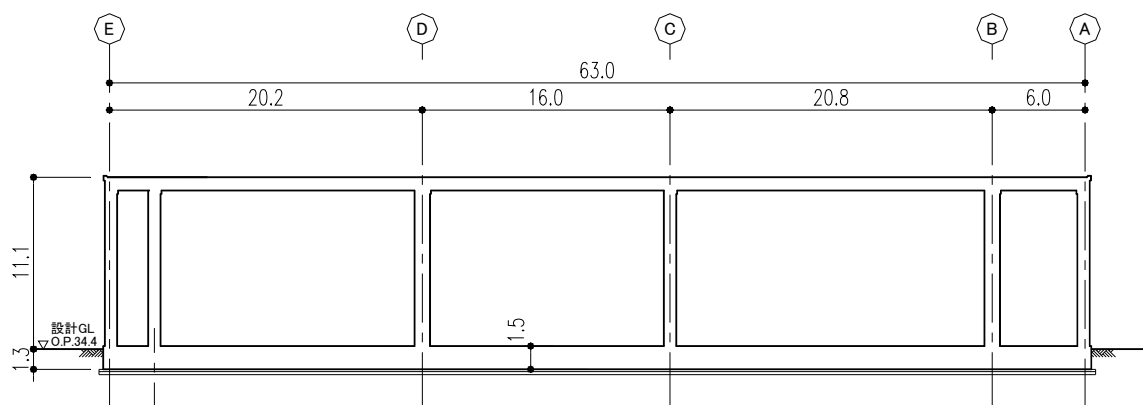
スラッジ棟 B-B断面図 (EW 方向) (単位：m)
